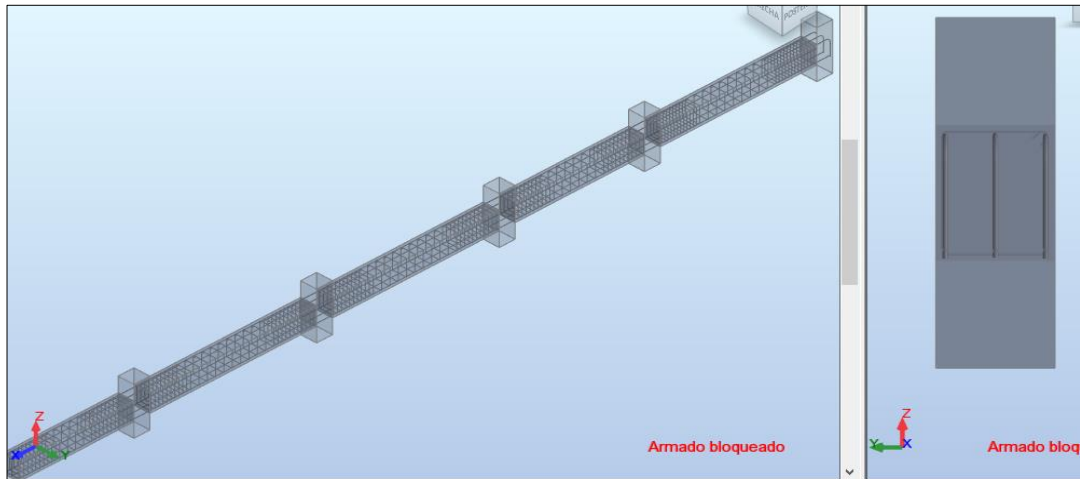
Distribución final de los aceros en los tramos 100-P1, 101-P2, 102-P3, 103-P4, 104-P5, 105-P6.
